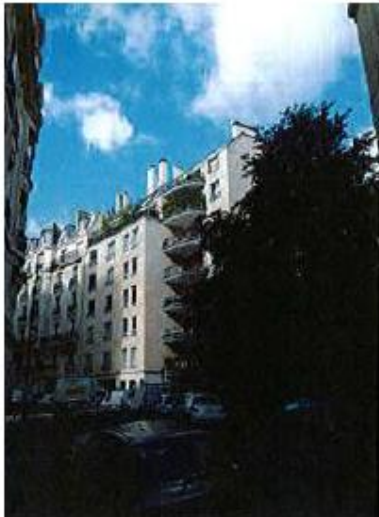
PHOTO DE L'IMMEUBLE APRES TRAVAUX
